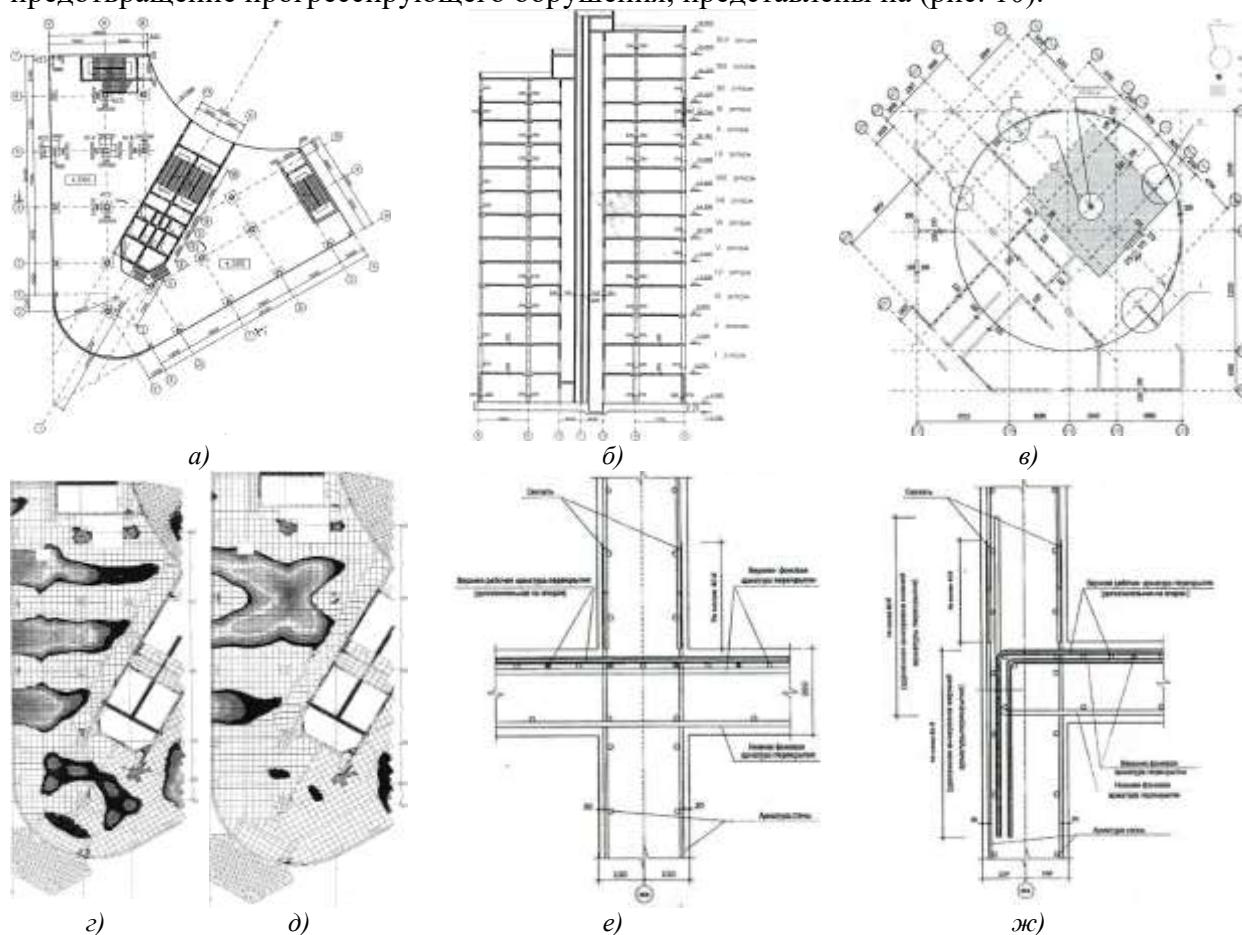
Схемы к результатам расчета и конструирования железобетонного каркаса здания по предотвращению прогрессирующего обрушения (СТО-008-02495342-2009)
